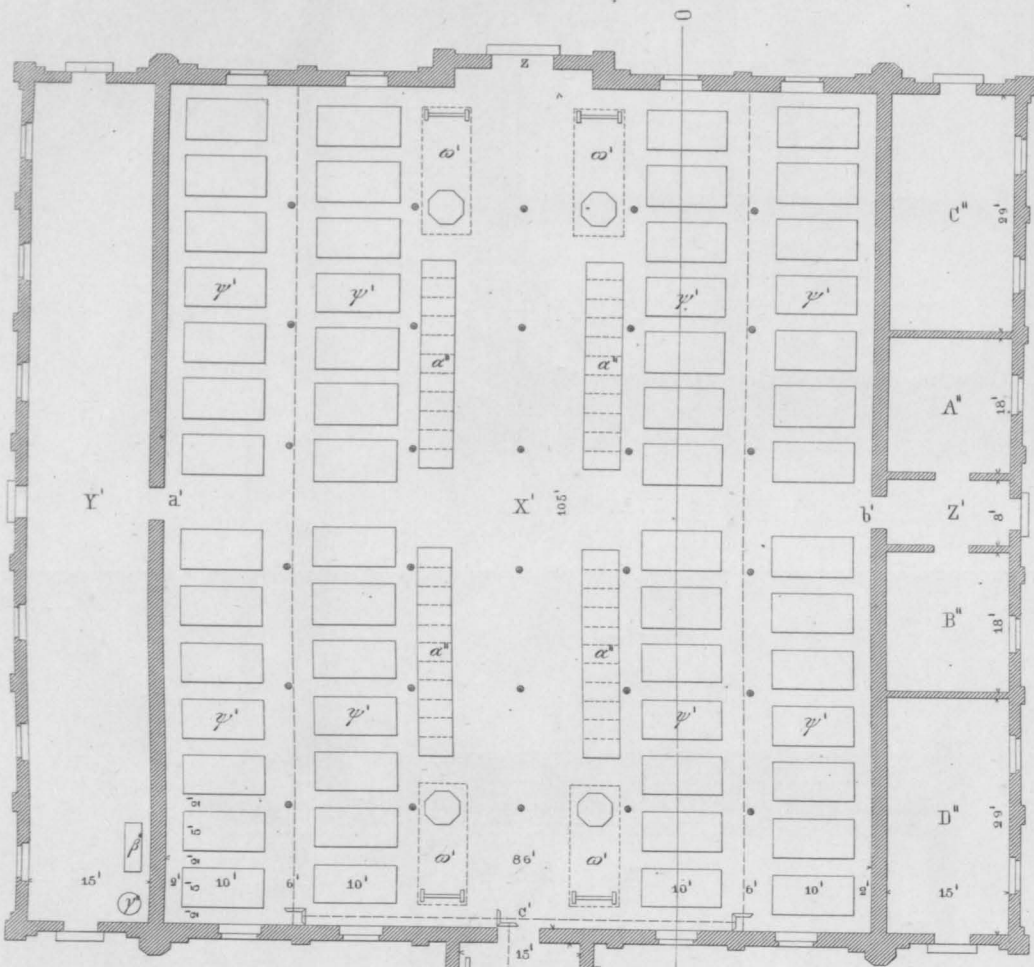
Grundriss des Kesselhauses und Webereigebäudes.
